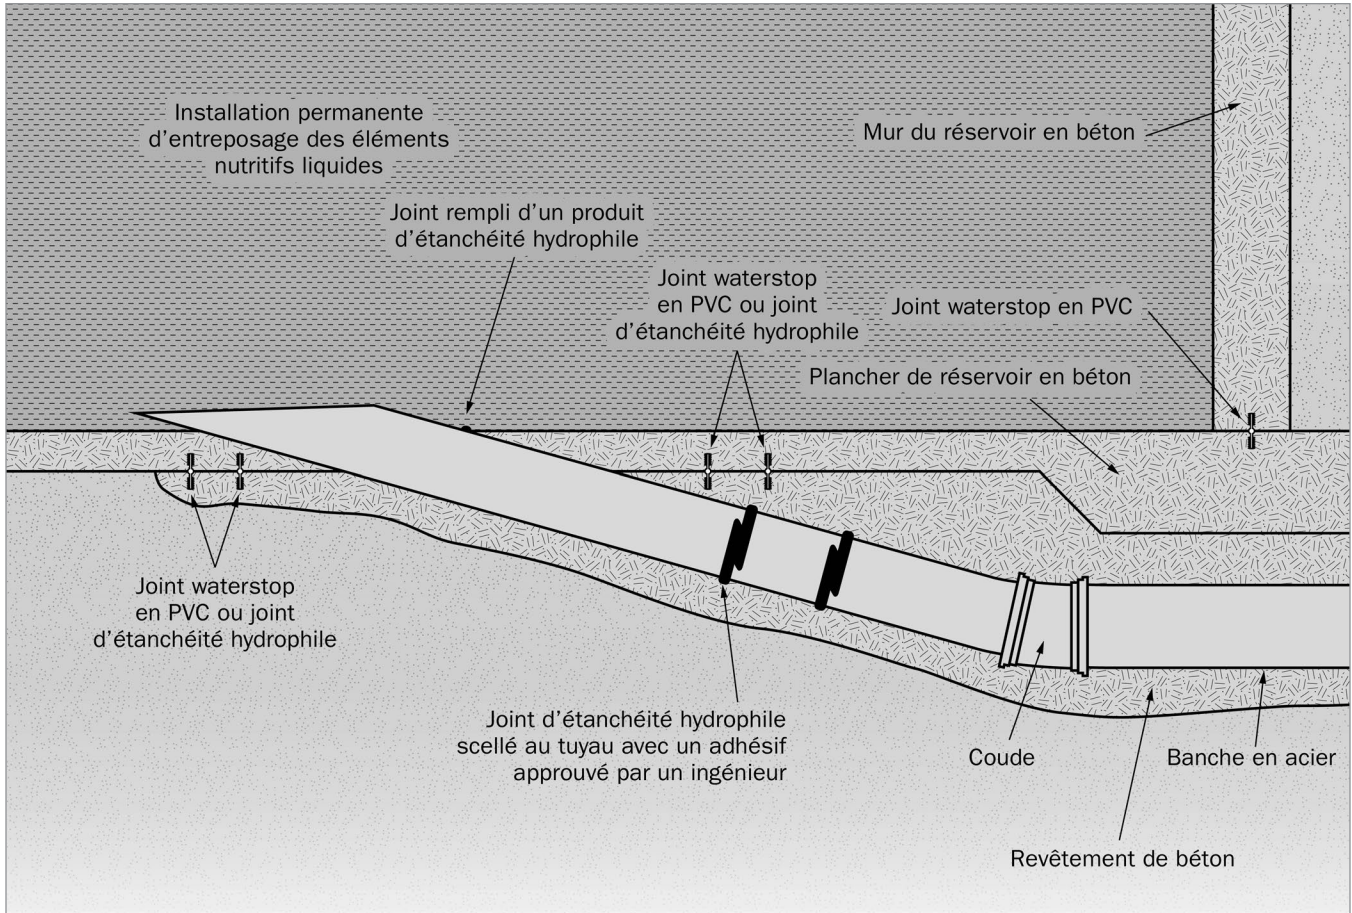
Joint d'étanchéité hydrophile : croquis d'une ouverture dans le plancher. Source : Dietrich Engineering Limited
